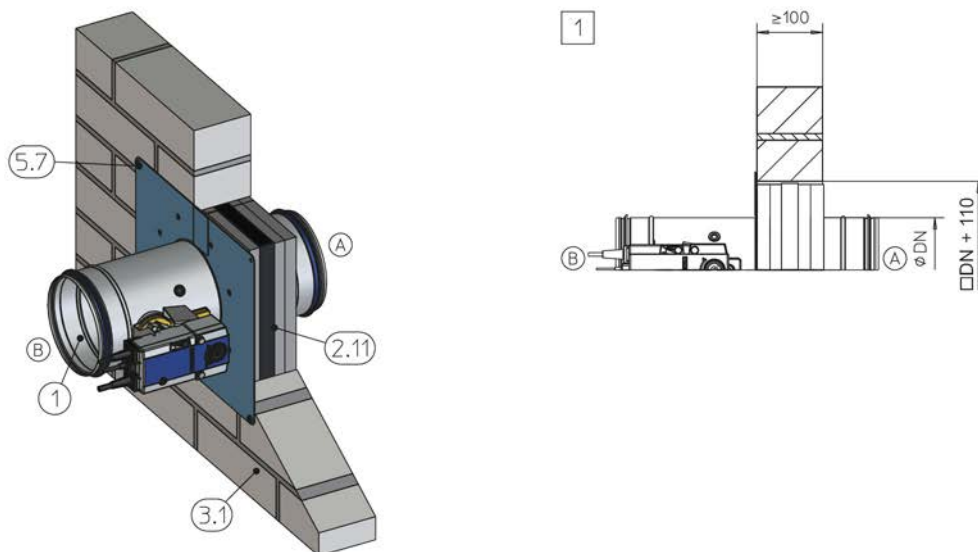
Installazione a secco senza malta con blocco di installazione ER
